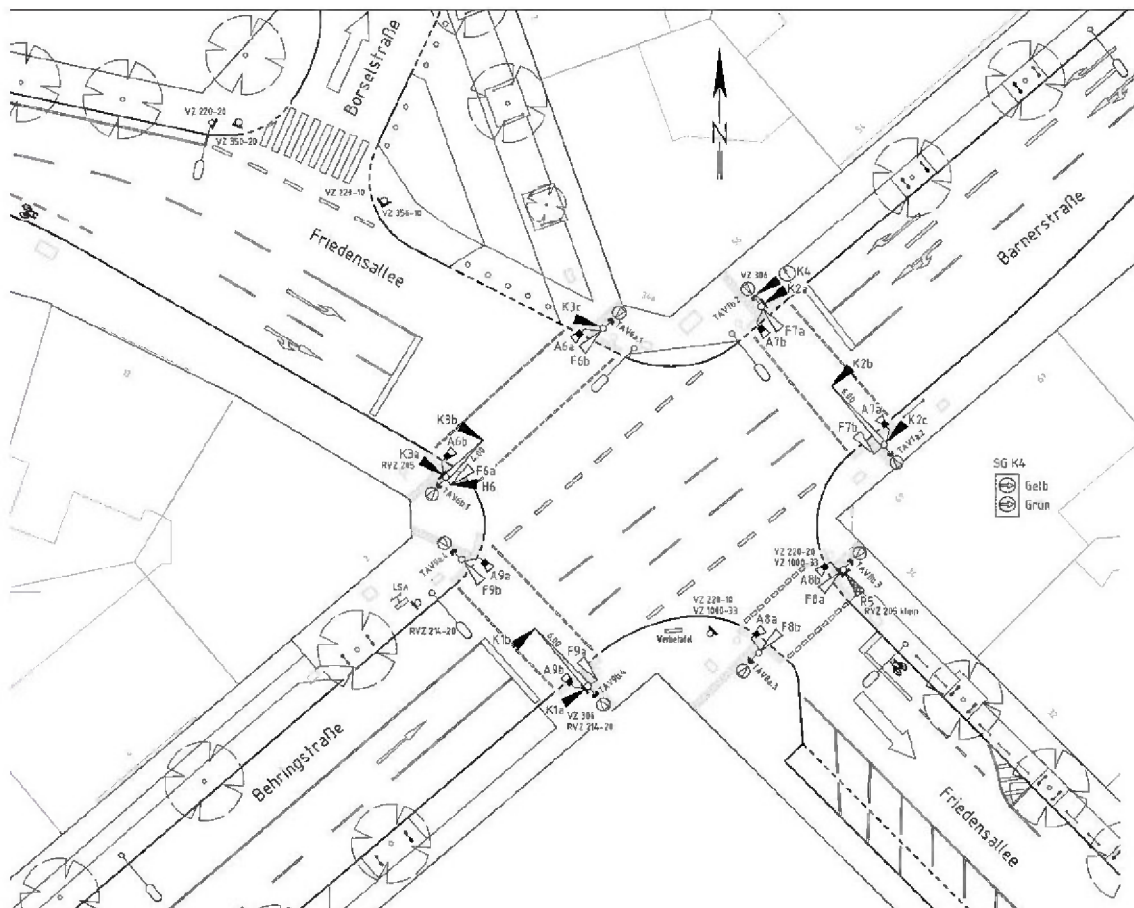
Signallageplan Barnerstraße/Friedensallee – Bestand (17/617-04-06/00)
